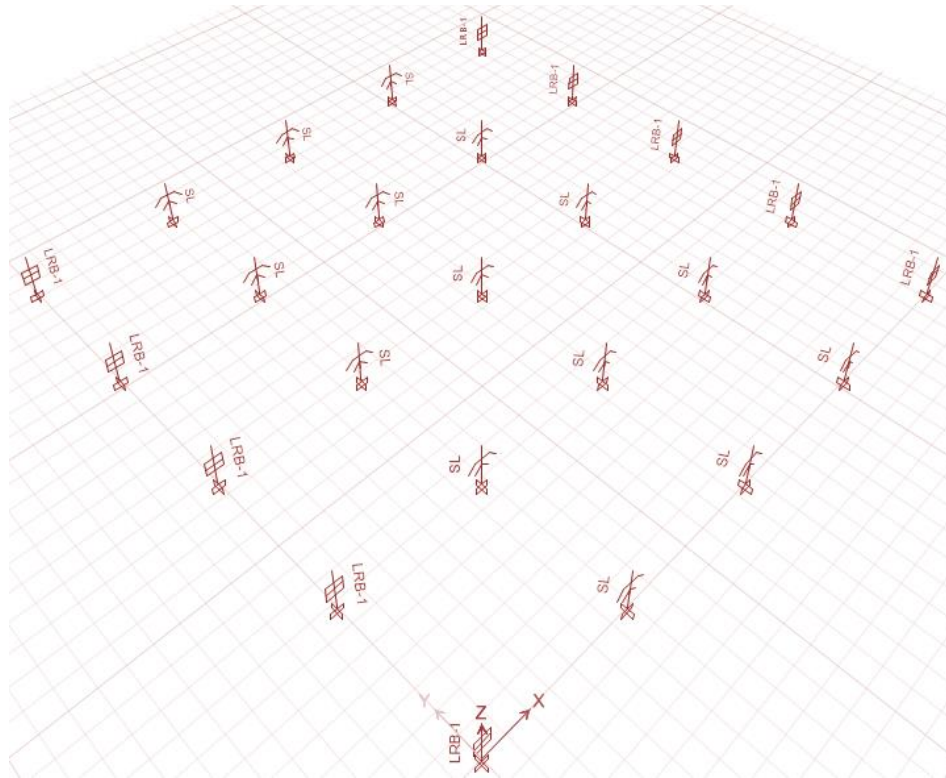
Distribución en Planta Aisladores tipo LRB y deslizador SL (Microzona Lacustre 200). Fuente: Propia.
